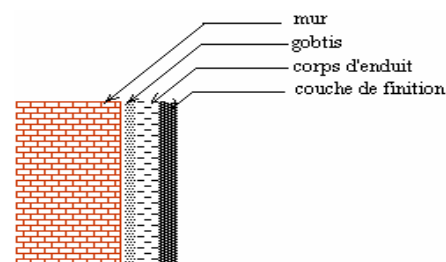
Différente couche d'enduit de recouvrement.
